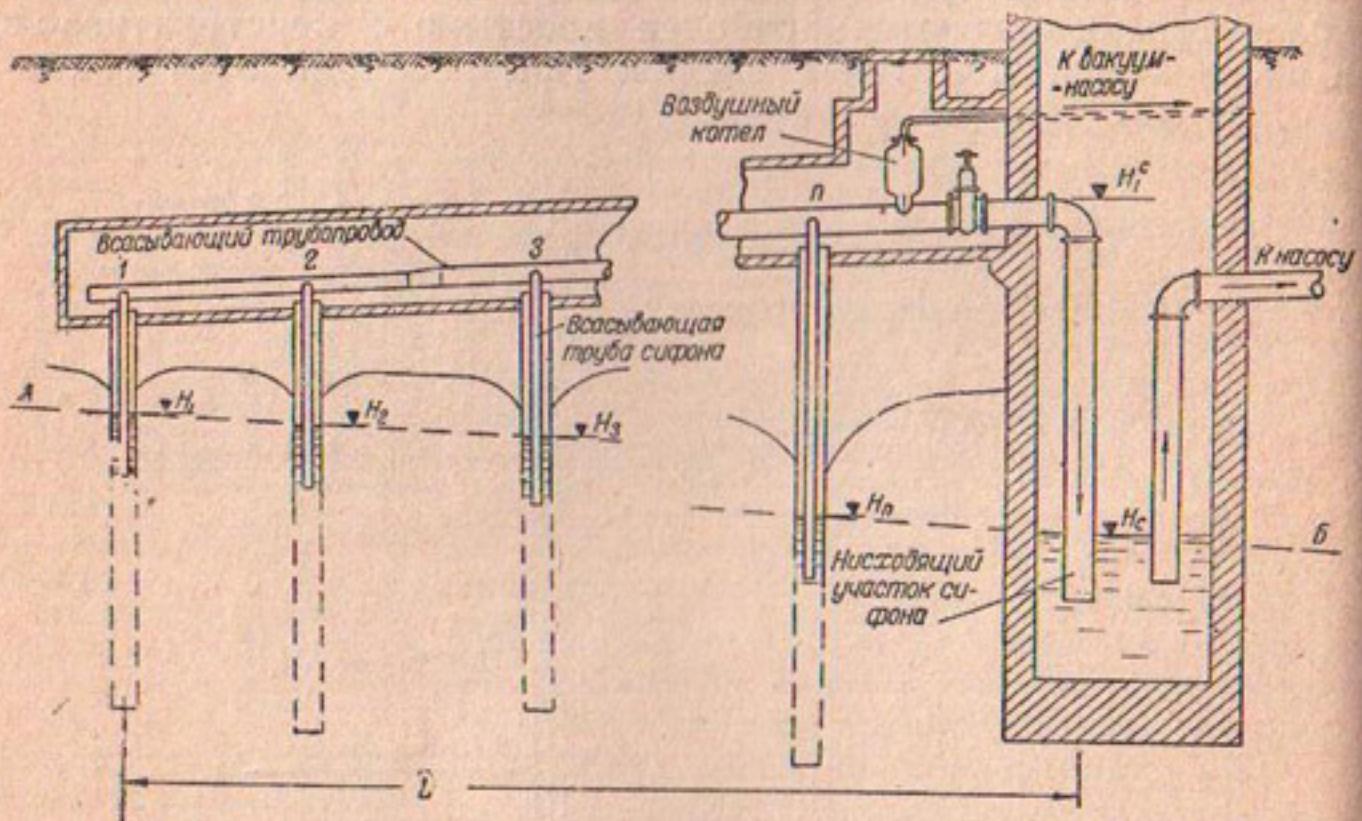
а. Схема дренажной завесы с всасывающим трубопроводом, присоединенным к насосу
